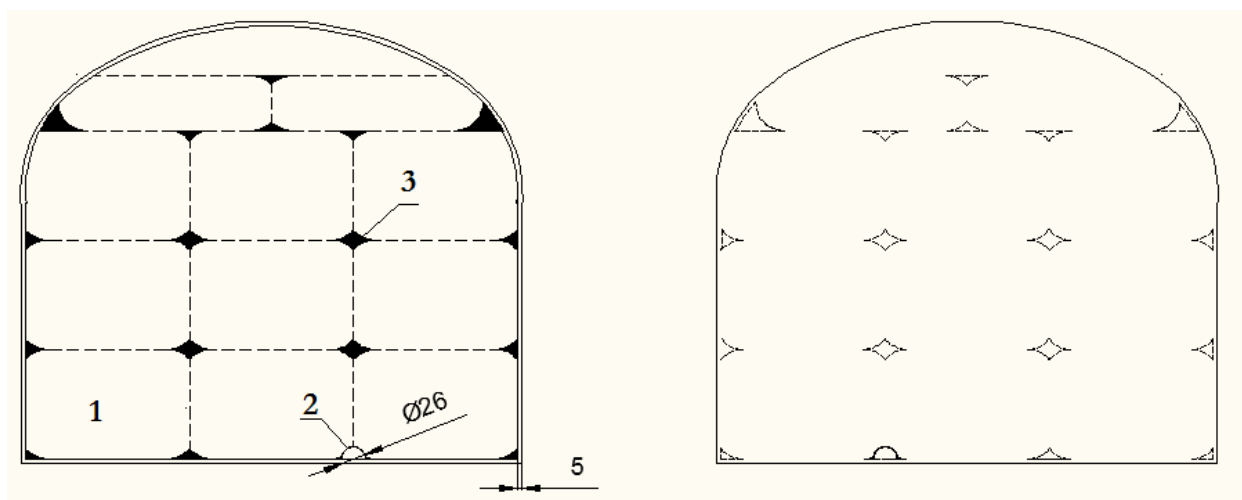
Чехол для пневматической перемычки № 2. 1 — Место для мягкой оболочки; 2 — Дренажная труба; 3 — Прорезиненный наполнитель
